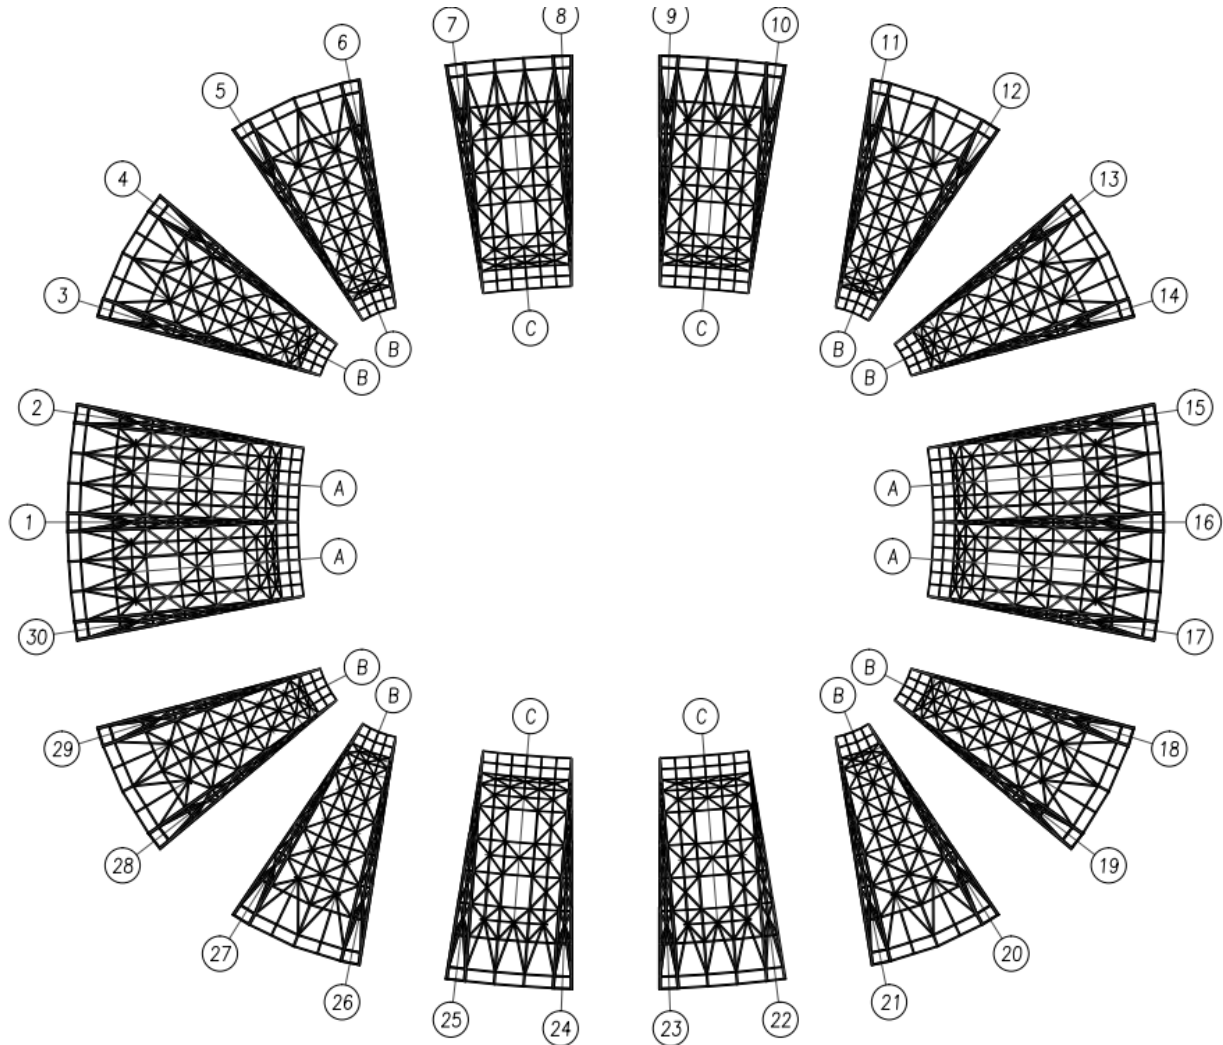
Vue en Plan des Treillis spatiaux secondaires
